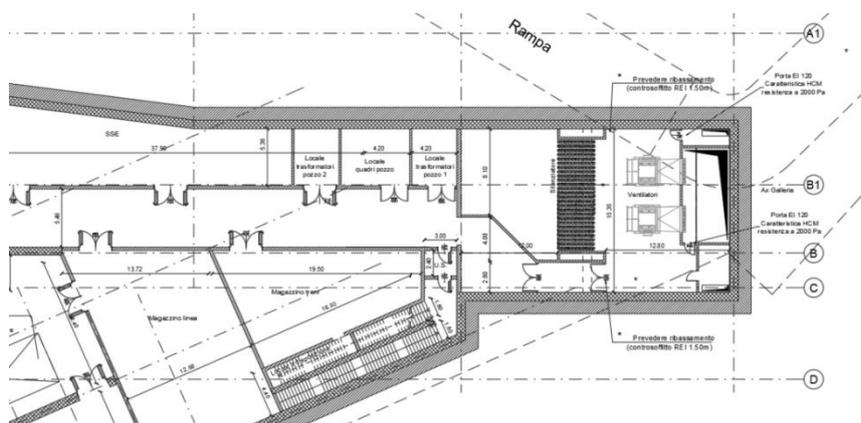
Pianta piano -1 area Pozzo Rebaudengo
